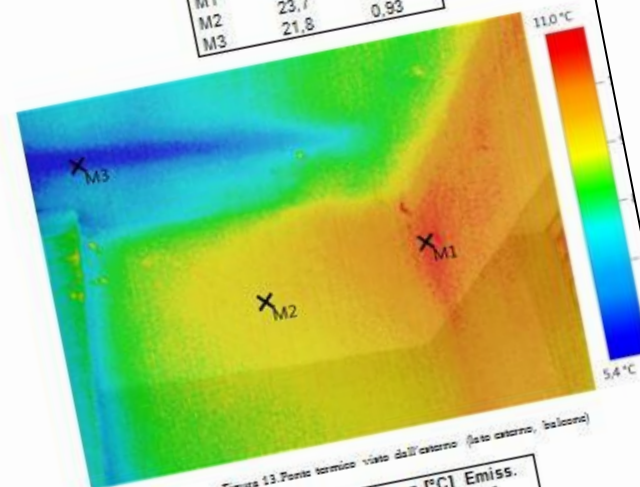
Ponte termico visto dall'esterno (foto esterno, balcone)
